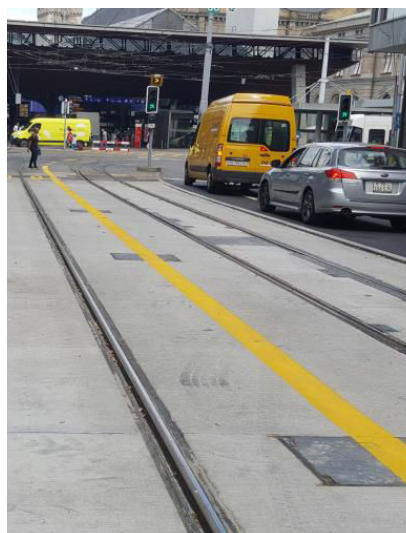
Helle Betonfahrbahn an der Löwenstrasse
